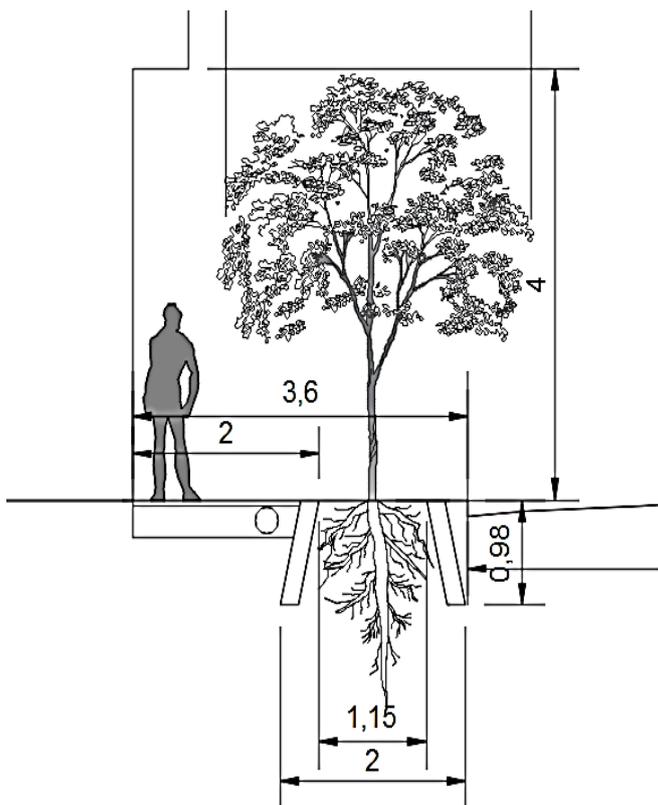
Propuesta de acera con una longitud de 3.6, con tazón reforzado de hormigón armado.
